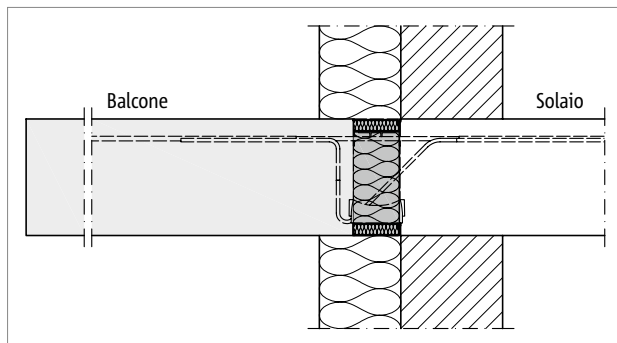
Schöck Isokorb® T tipo Z, K: sistema di isolamento a cappotto
